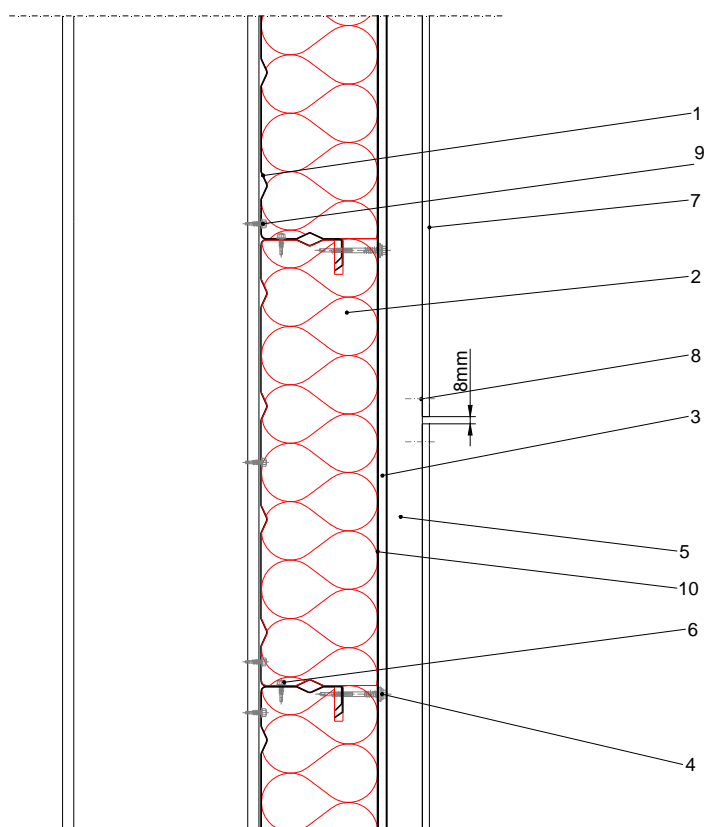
Coupe verticale en partie courante (avec tôle pare-pluie)
